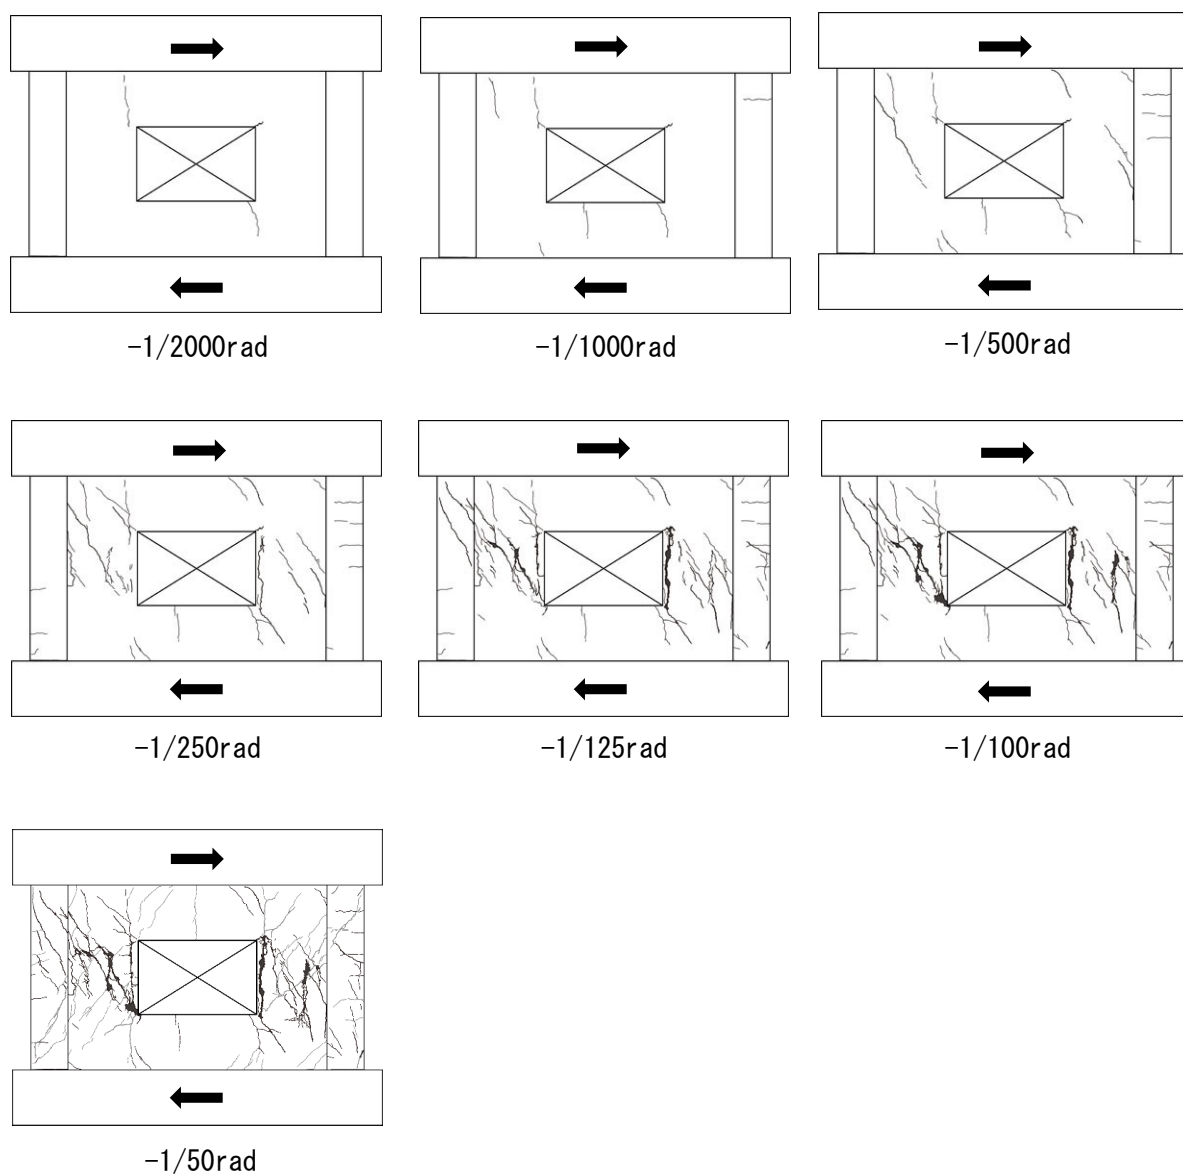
各層間変形角のひび割れ状況図 (F7-SWC-1.0) (続き)
